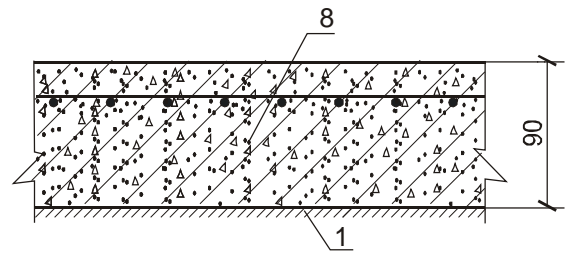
Конструкция дорожной одежды на железобетонной плите
